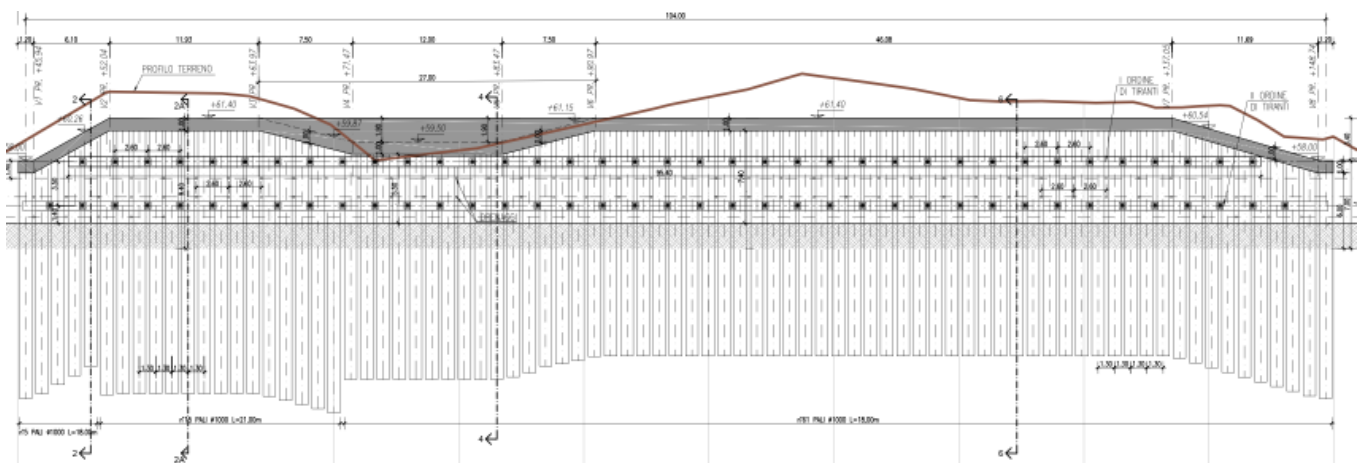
Dettaglio profilo berlinese con le quattro sezioni tipo
